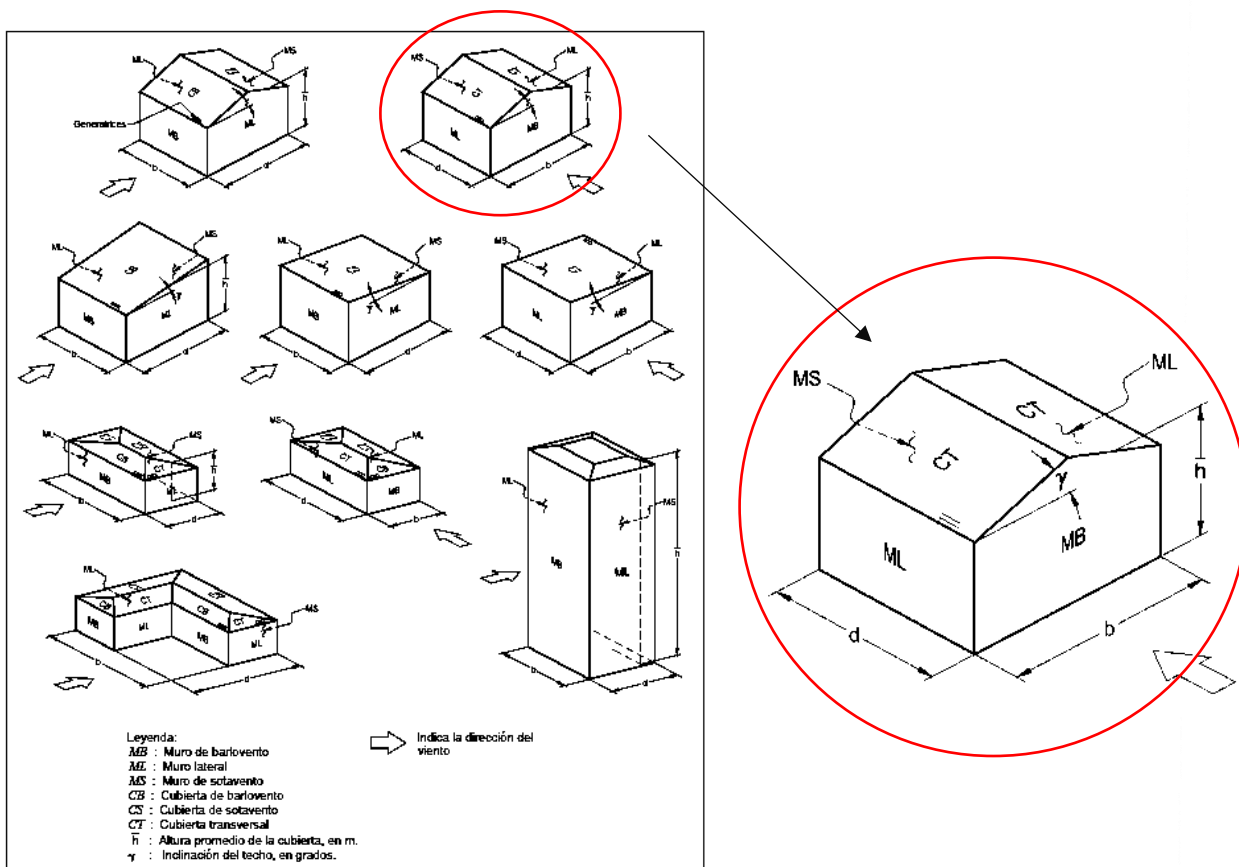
Definición de parámetros de construcciones con planta cerrada, (CFE, 2008, pág. 4.3 l. 9)
